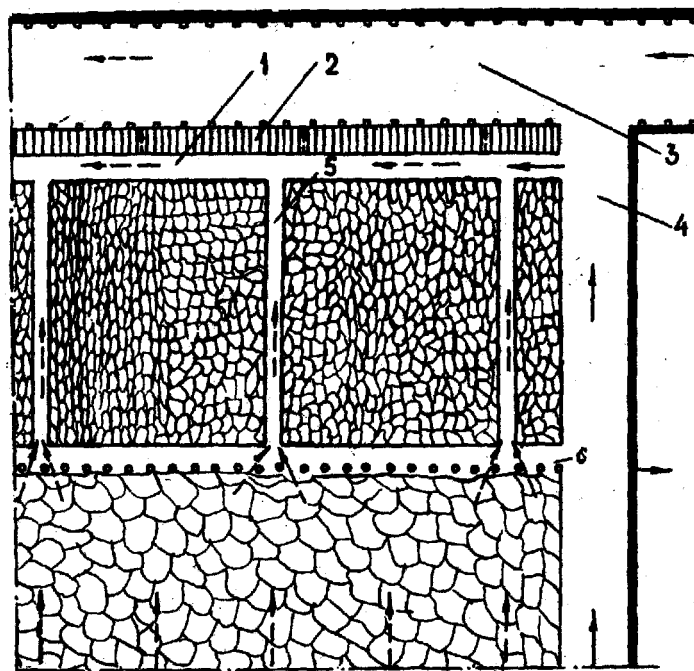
Схема устройства каналов в бутовой полосе: 1 – продольный канал; 2 – стенка; 3 – вентиляционная выработка; 4 – лава; 5 – поперечный канал; 6 – просек
